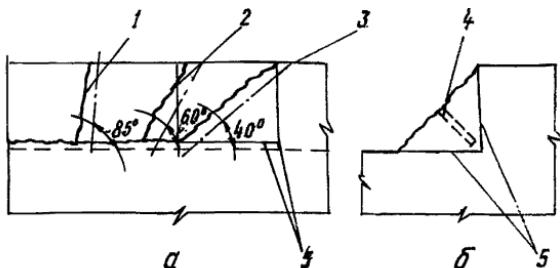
Характерные профили отколов при разрушении бетонного фундамента и регулировании угла откола:
